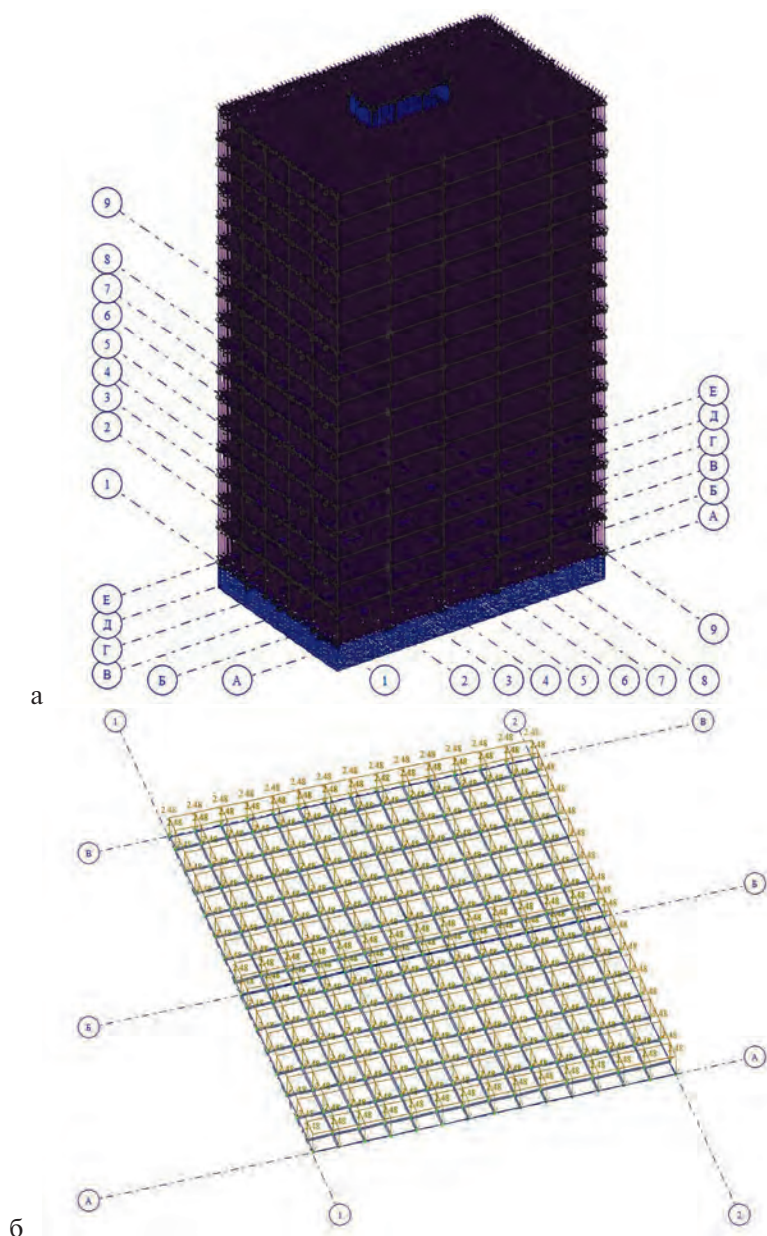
Загружение № 3. Нагрузка на всю расчетную схему (а) и фрагмент перекрытия с равномерно распределенной нагрузкой (б)
